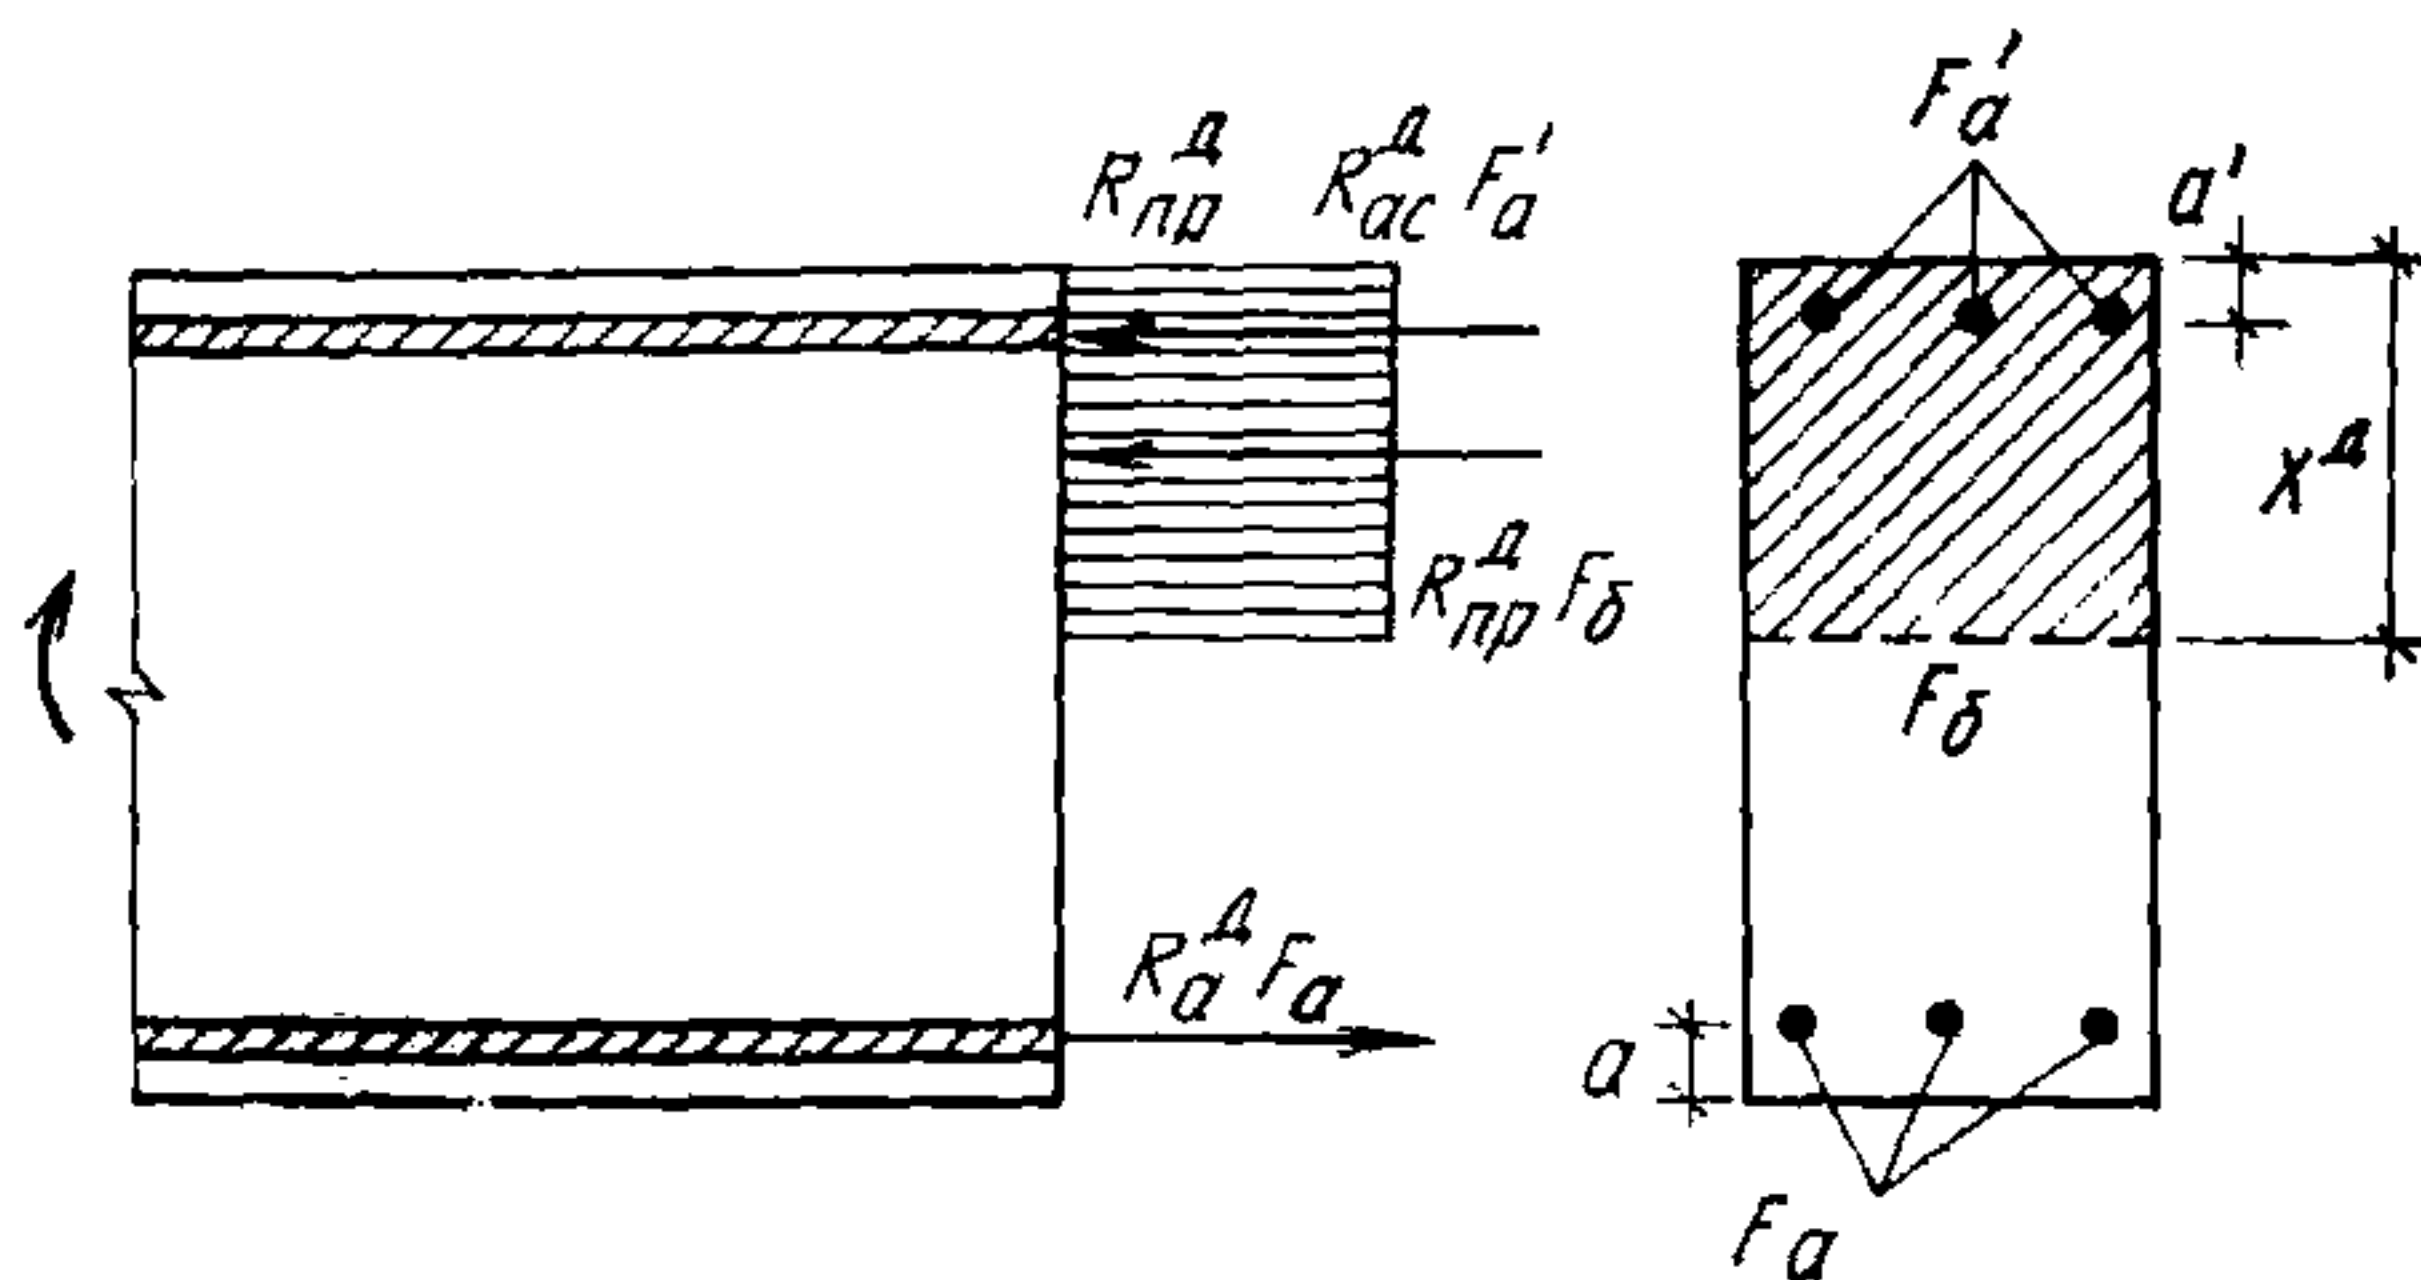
Схема усилий в нормальном сечении железобетонного элемента при расчете его прочности
